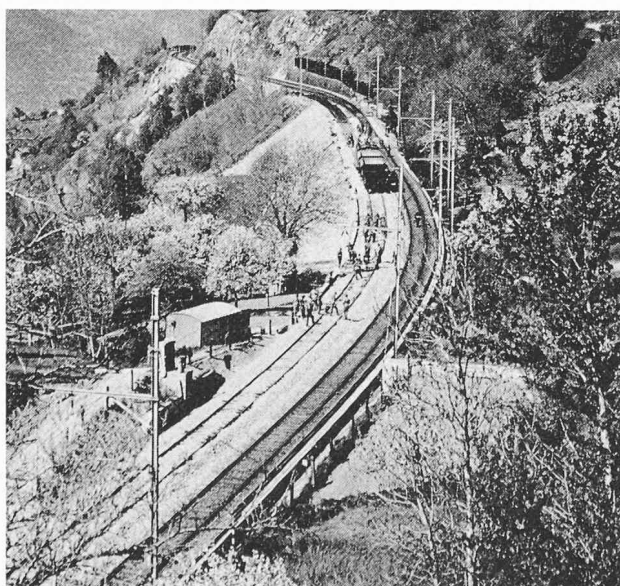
Construction d'une voie d'évitement de 1566 m à Ausserberg, sur la rampe sud (photo BLS).
